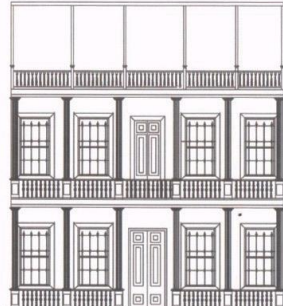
Análisis de la composición de fachada para futuras normas arquitectónicas.
